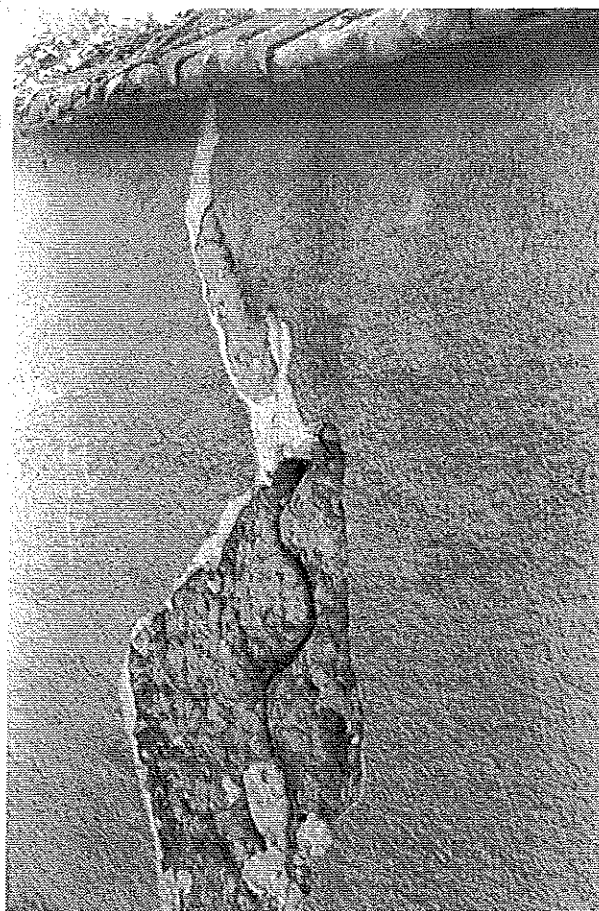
Fissure verticale importante dans un mur de clôture en pisé suite à un tassement de fondation.
